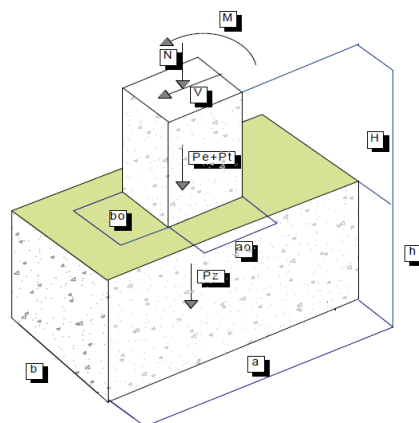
Zapata. Fuente: Sánchez, F.J., (2017). Taller estructuras de edificación, construcción y elementos constructivos. Universitat Politècnica de València. Valencia.
